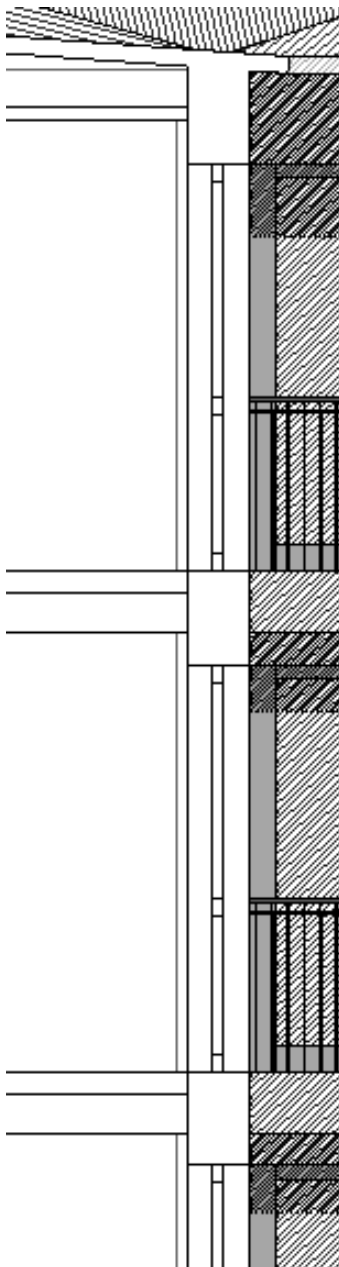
Planausschnitt Vorprojekt des Architekten.
